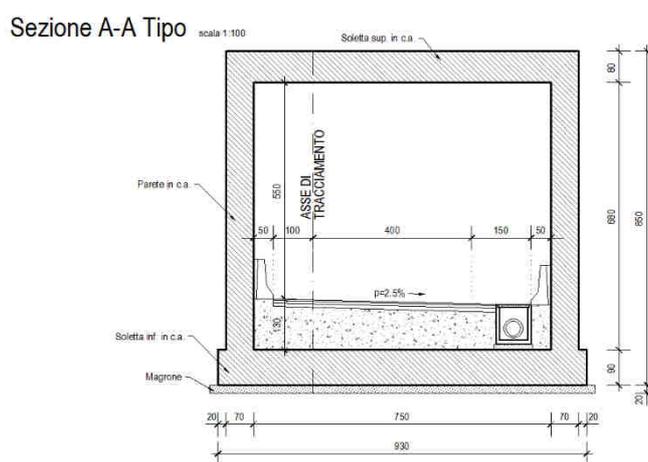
Sezione trasversale tipologica - Sottovia svincolo SS.125 ramo B
